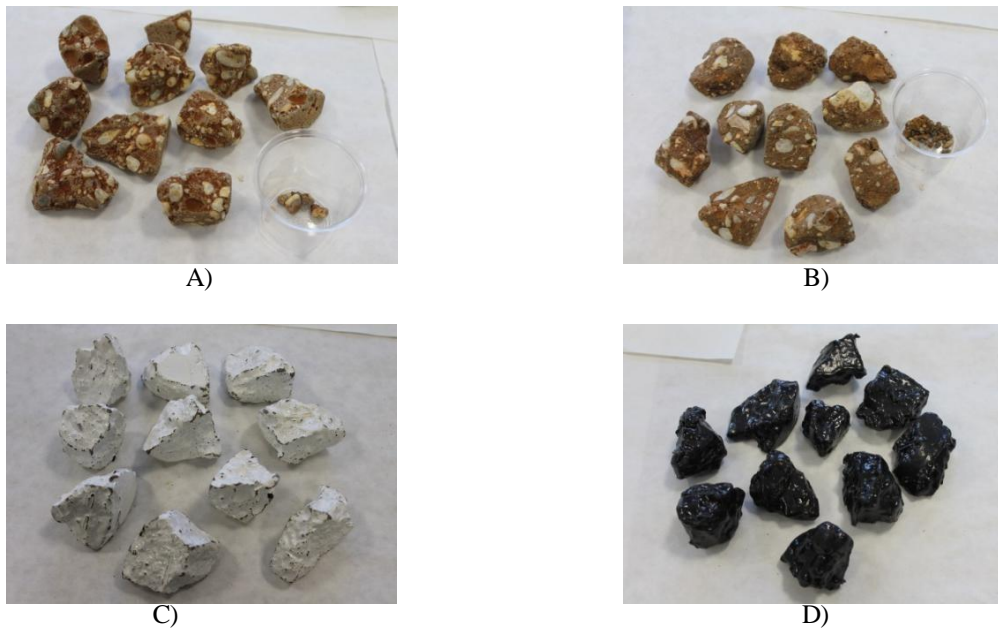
Estado final de las muestras en el ensayo Slake: A) Hormigón de referencia; B) Hormigón con fibras; C) Hormigón con poliuretano y D) Hormigón con base asfáltica
